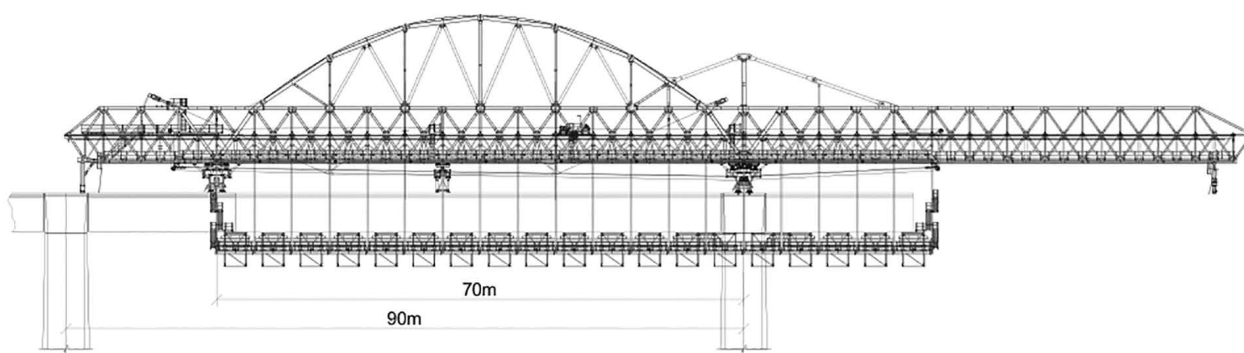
Alzado de la cimbra autolanzable M1-90-S.
